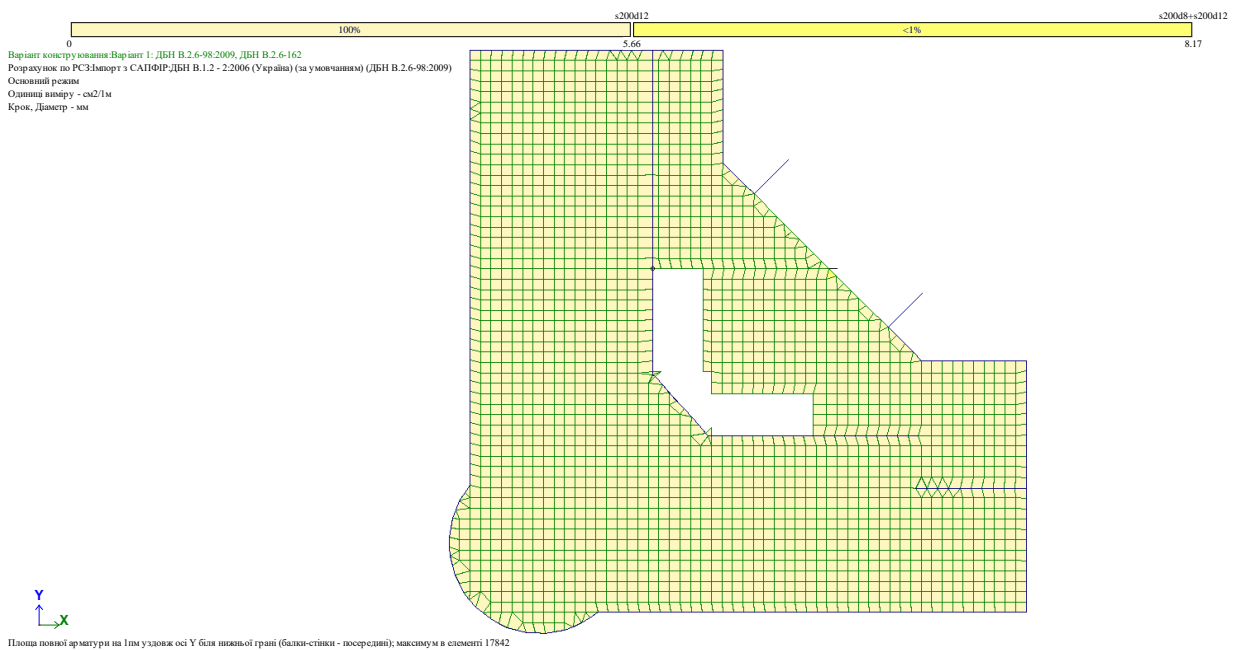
Площа повної арматури на 1м уздовж осі Y біля нижньої грані (балки-стілки - посередині) для плити перекриття 2-го поверху
